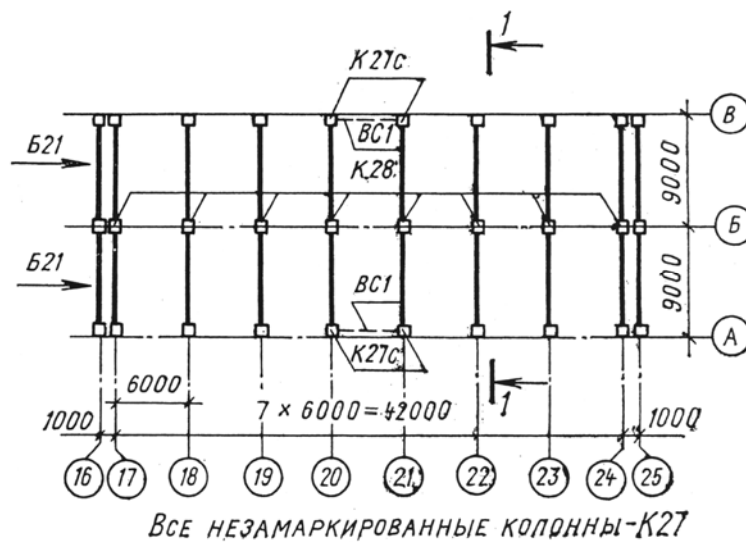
Маркировочная схема колонн и балок перекрытия на отм. +4.800
